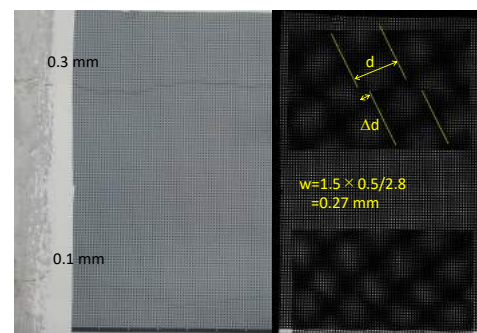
ひび割れの様子(左)と画像解析(右)
